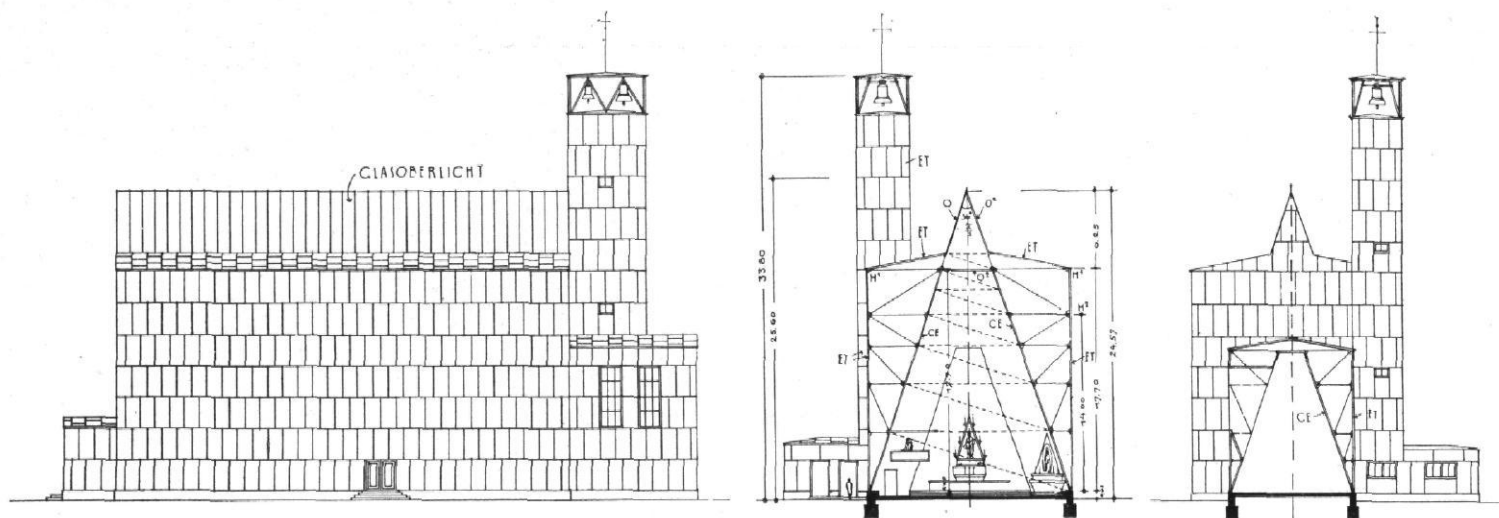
bis 3 | Entwurf zu einer Stahlkirche | Architekt: Josef Weidenbacher, Augsburg | Ansicht, Schnitt A-B und C-D 1:600
